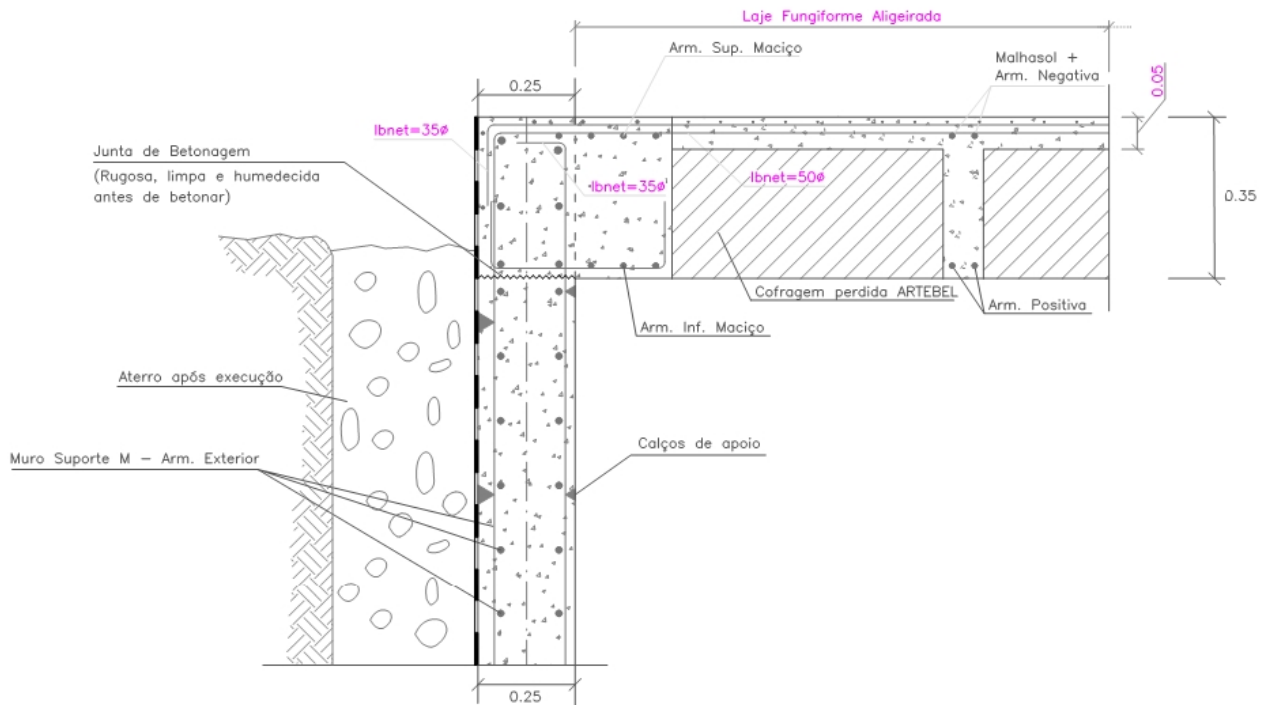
Pormenor da ligação da laje ao muro de suporte
